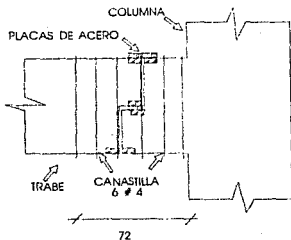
DETALLE DE UNION TRABE - COLUMNA
